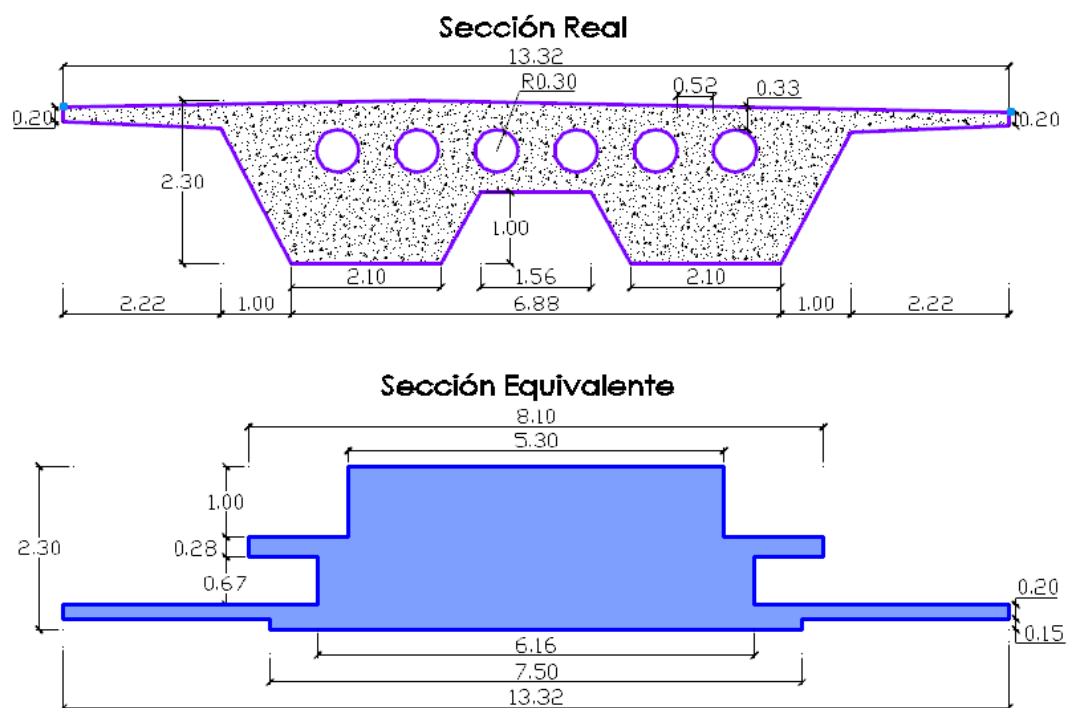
Sección sobre apoyo Pila 3, H=2.30m.
